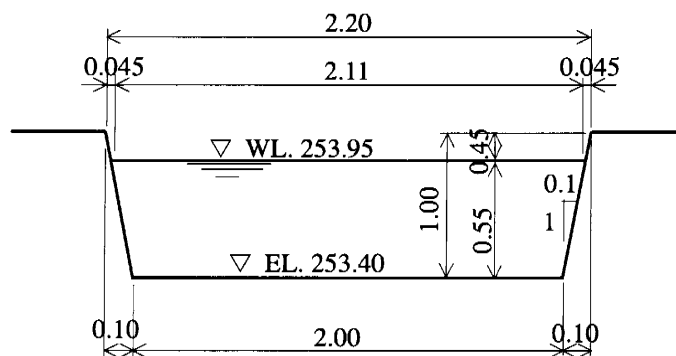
幹線水路始点断面 (STA. 0 + 030)
